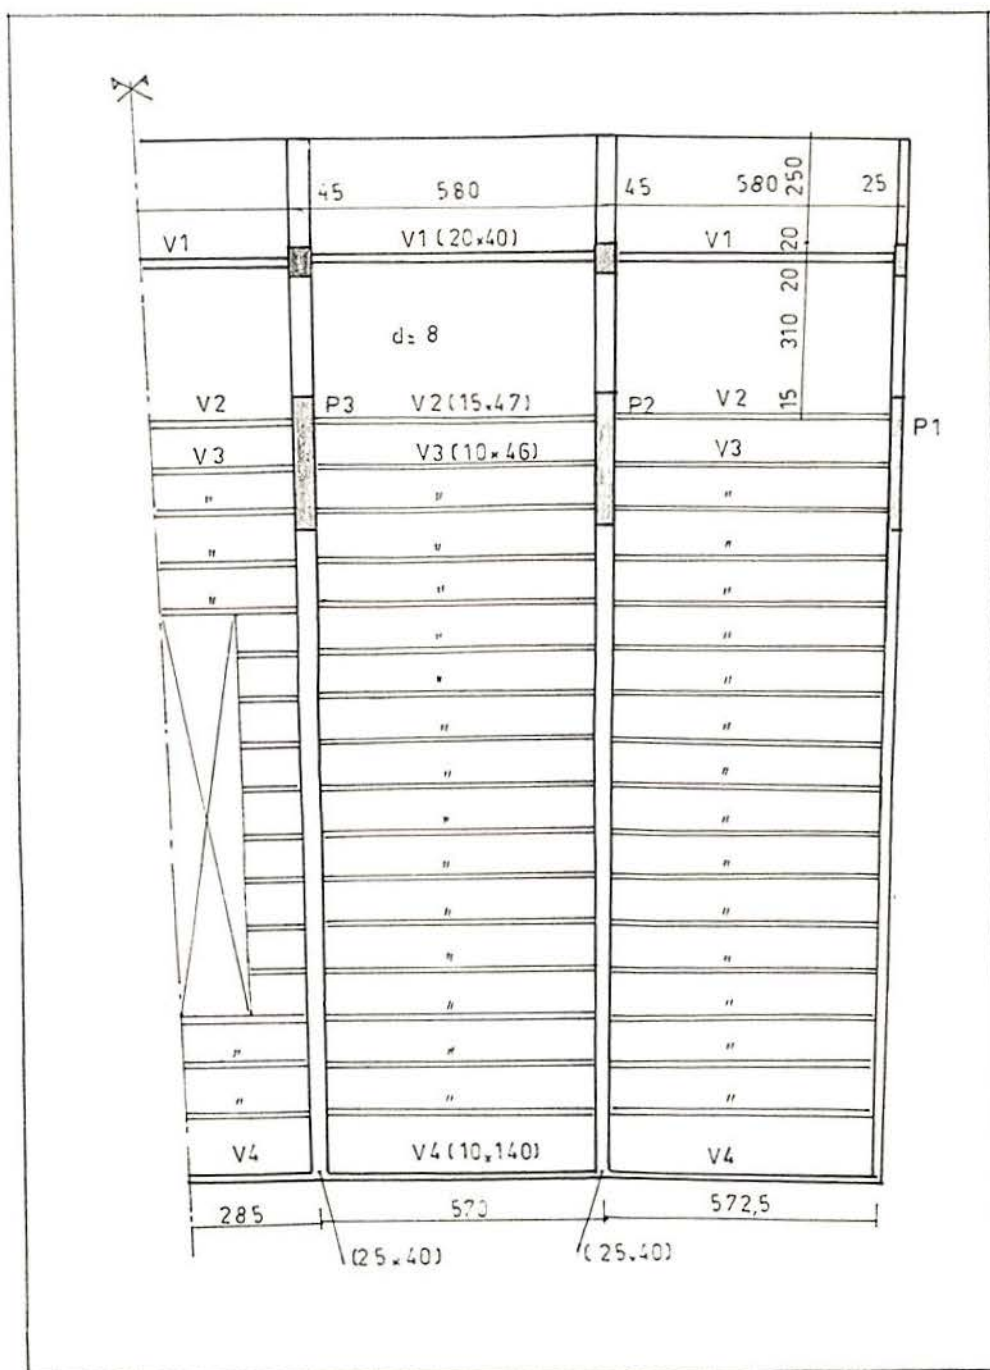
Vista superior da arquibancada. Dimensões das vigas e lajes, espessura dos pórticos.
